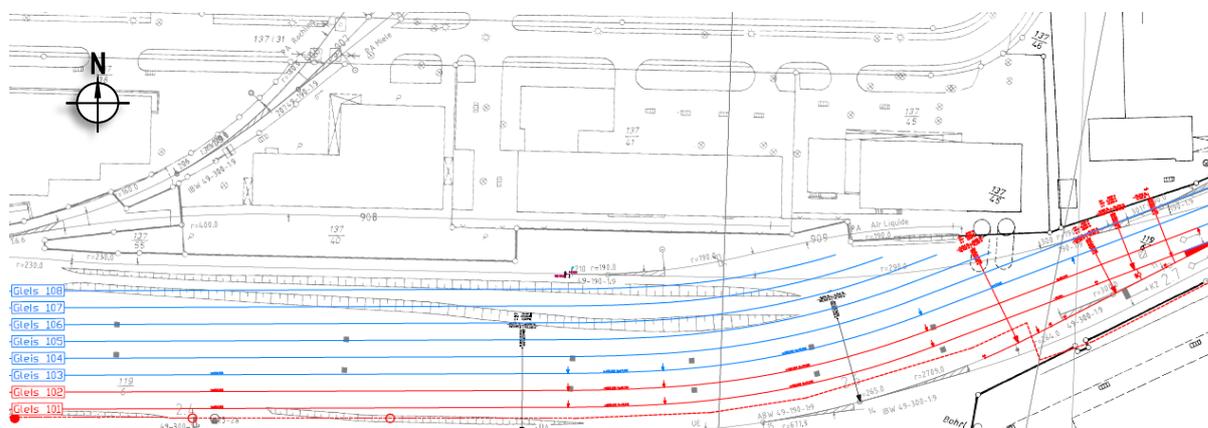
Lageplan mit Ausschnitt der APS-Gleise (Gleise 101 und 102 in „rot“, Gleise 103 bis 108 in „blau“)
